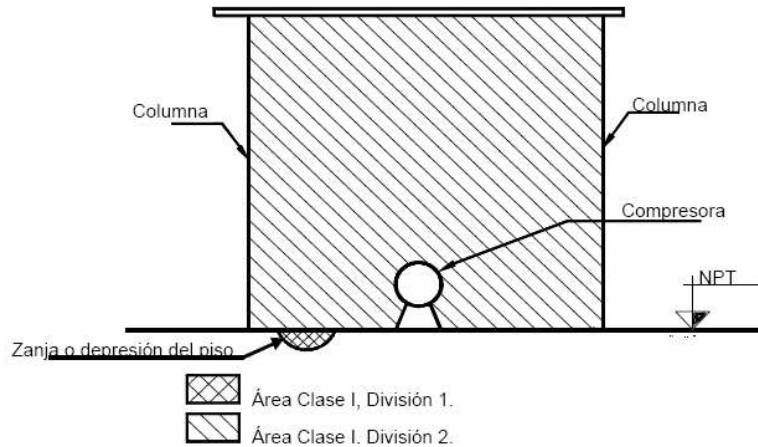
Áreas clasificadas en compresores instalados en estructuras techadas sin paredes, libremente ventilados.
